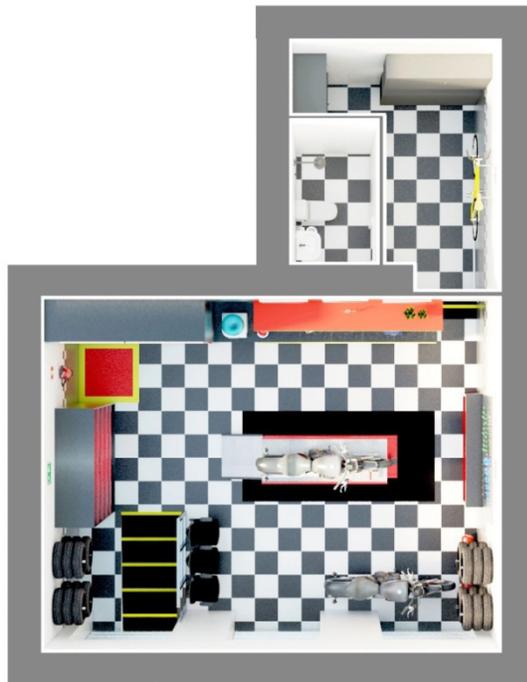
Planta baixa humanizada, para melhor visualização do layout proposto
